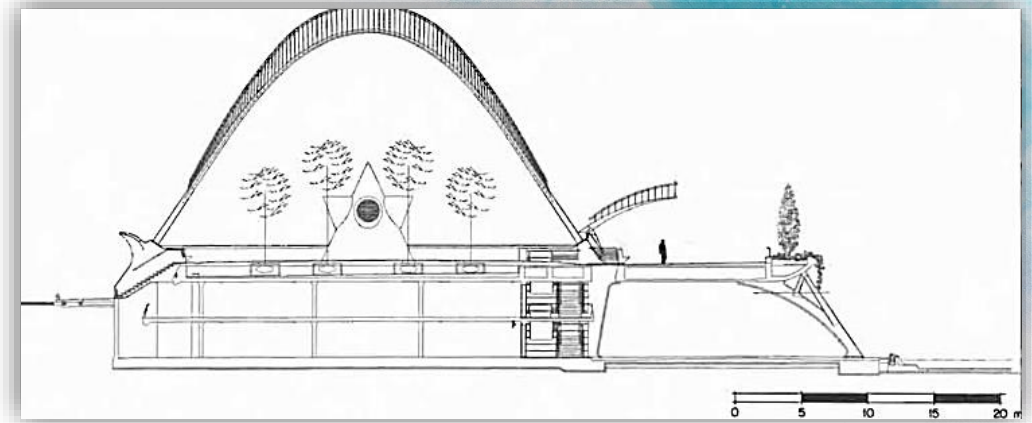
L'Hemisfèric. Corte Transversal Estacionamiento
